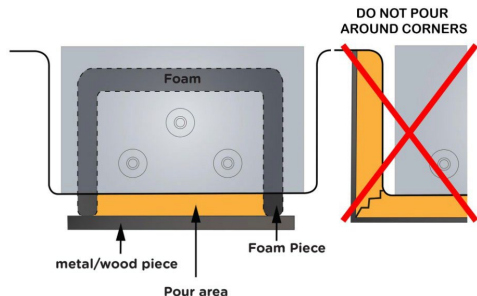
Использование деревянной или металлической планки в качестве передней стенки опалубки
